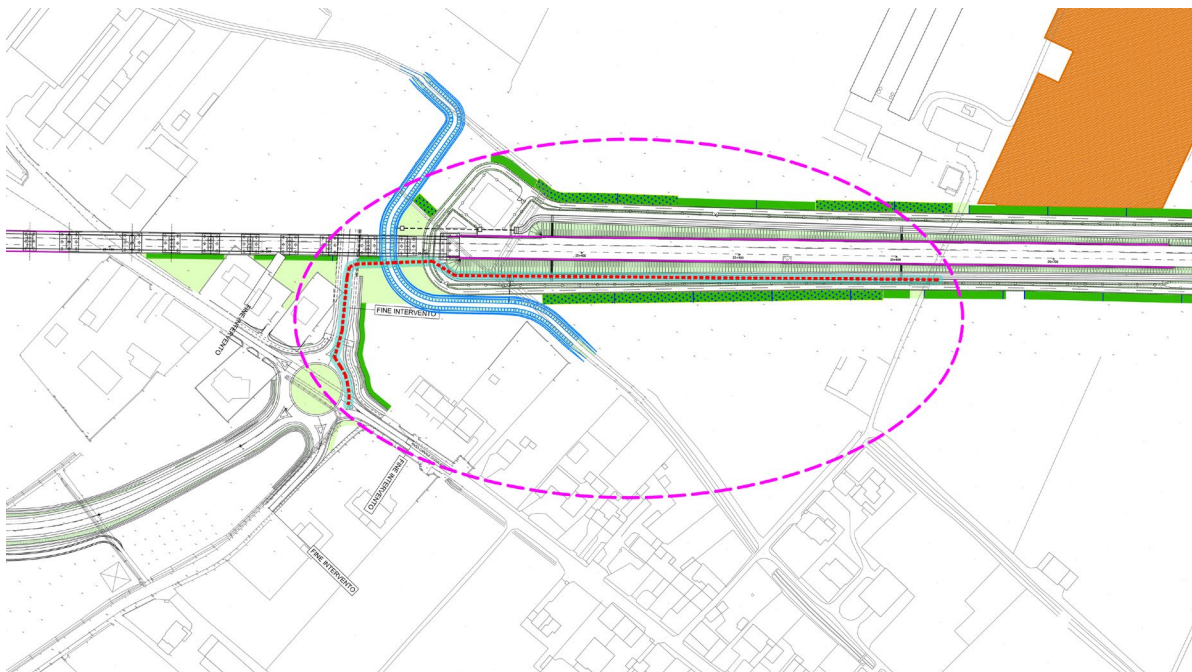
Stralcio Planimetria di PE con linea tratteggiata rossa è riportato il tracciato del cavidotto
